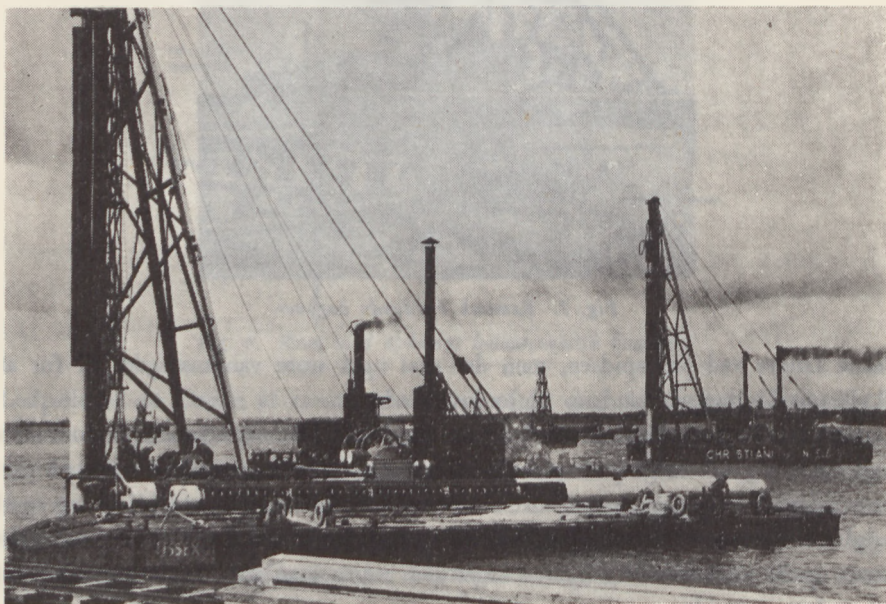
Ramning af hule cylindriske jernbetonpæle fra flydende materiel.
